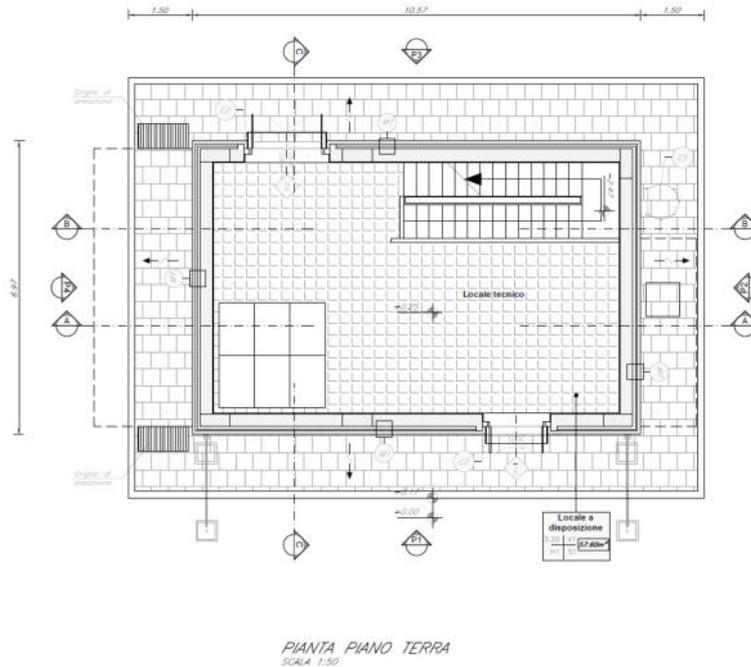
Pianta piano terra locale di pressurizzazione e impianto antincendio - E1 (FA-B)
